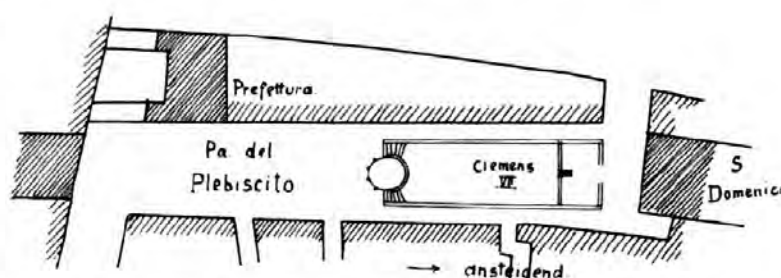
Ancona, Piazza del Plebiscito. Grundriß.
